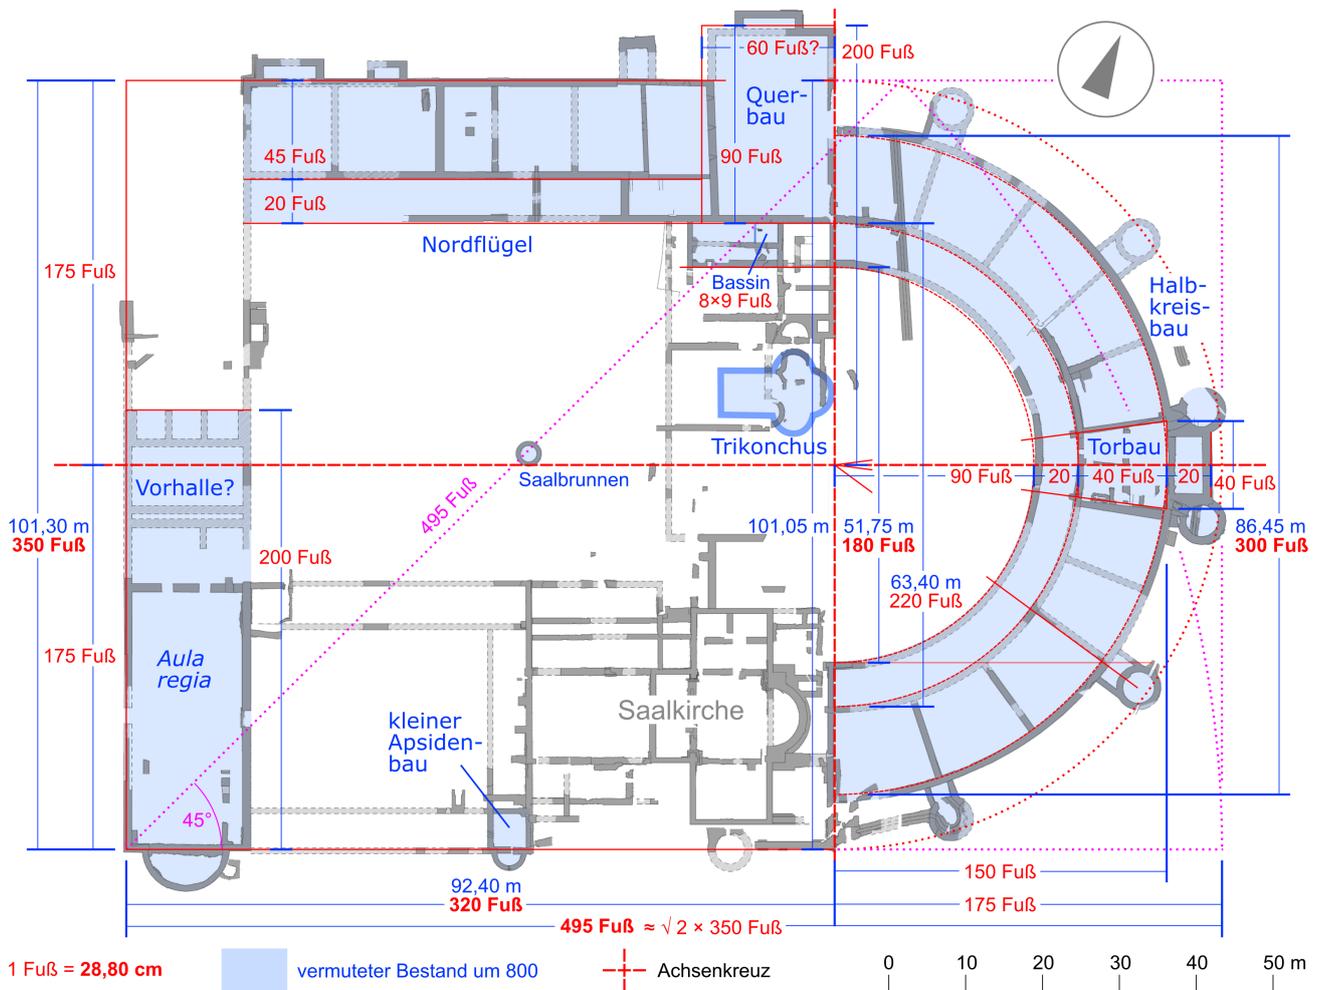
Der Grundriss der Ingelheimer Pfalz. Plan: Stadt Ingelheim, Radosław Myszk, 2014/Thomas Raab, 2015
